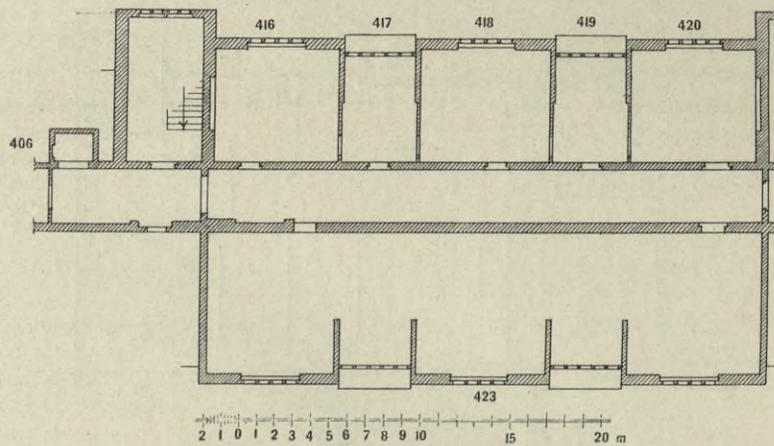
Techn.-chem. Institut, Dachgeschoß.
